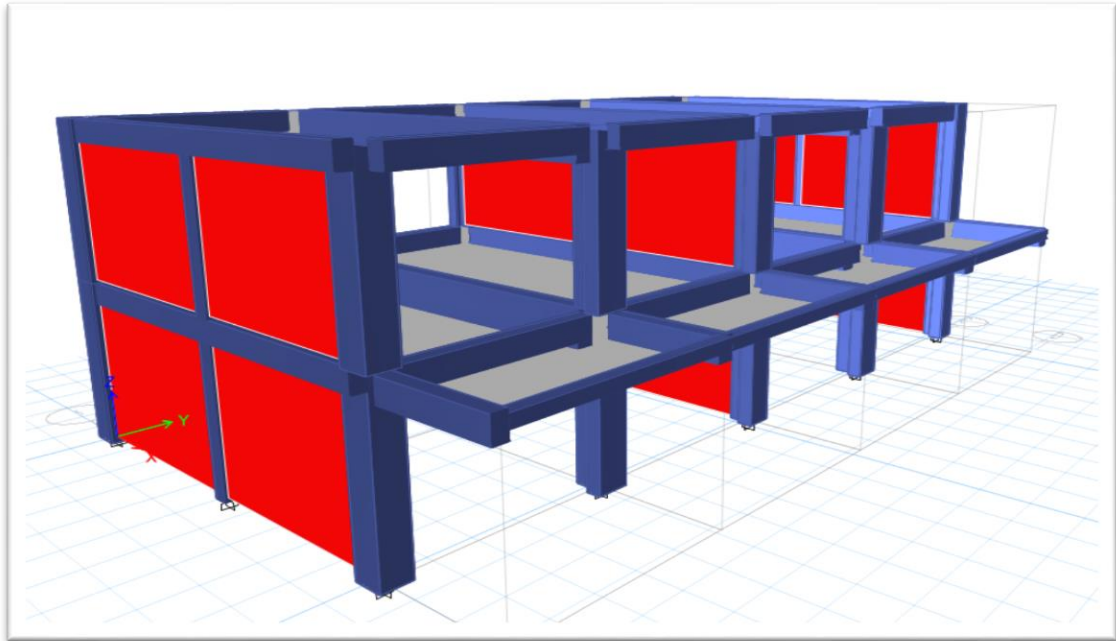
Modelado de las columnas “T” y “L”- vista en 3D
